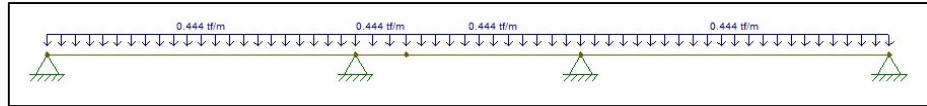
Modelo de viga considerando tabiquería por m^2
